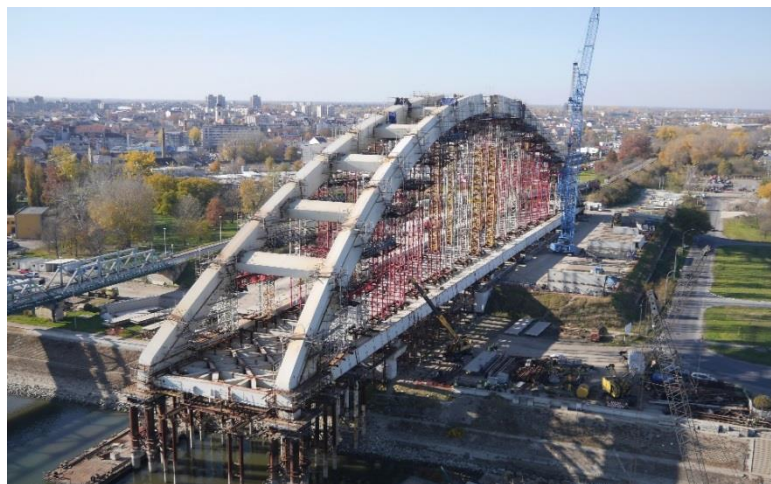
Montaža elemenata donjeg dela konstrukcije
